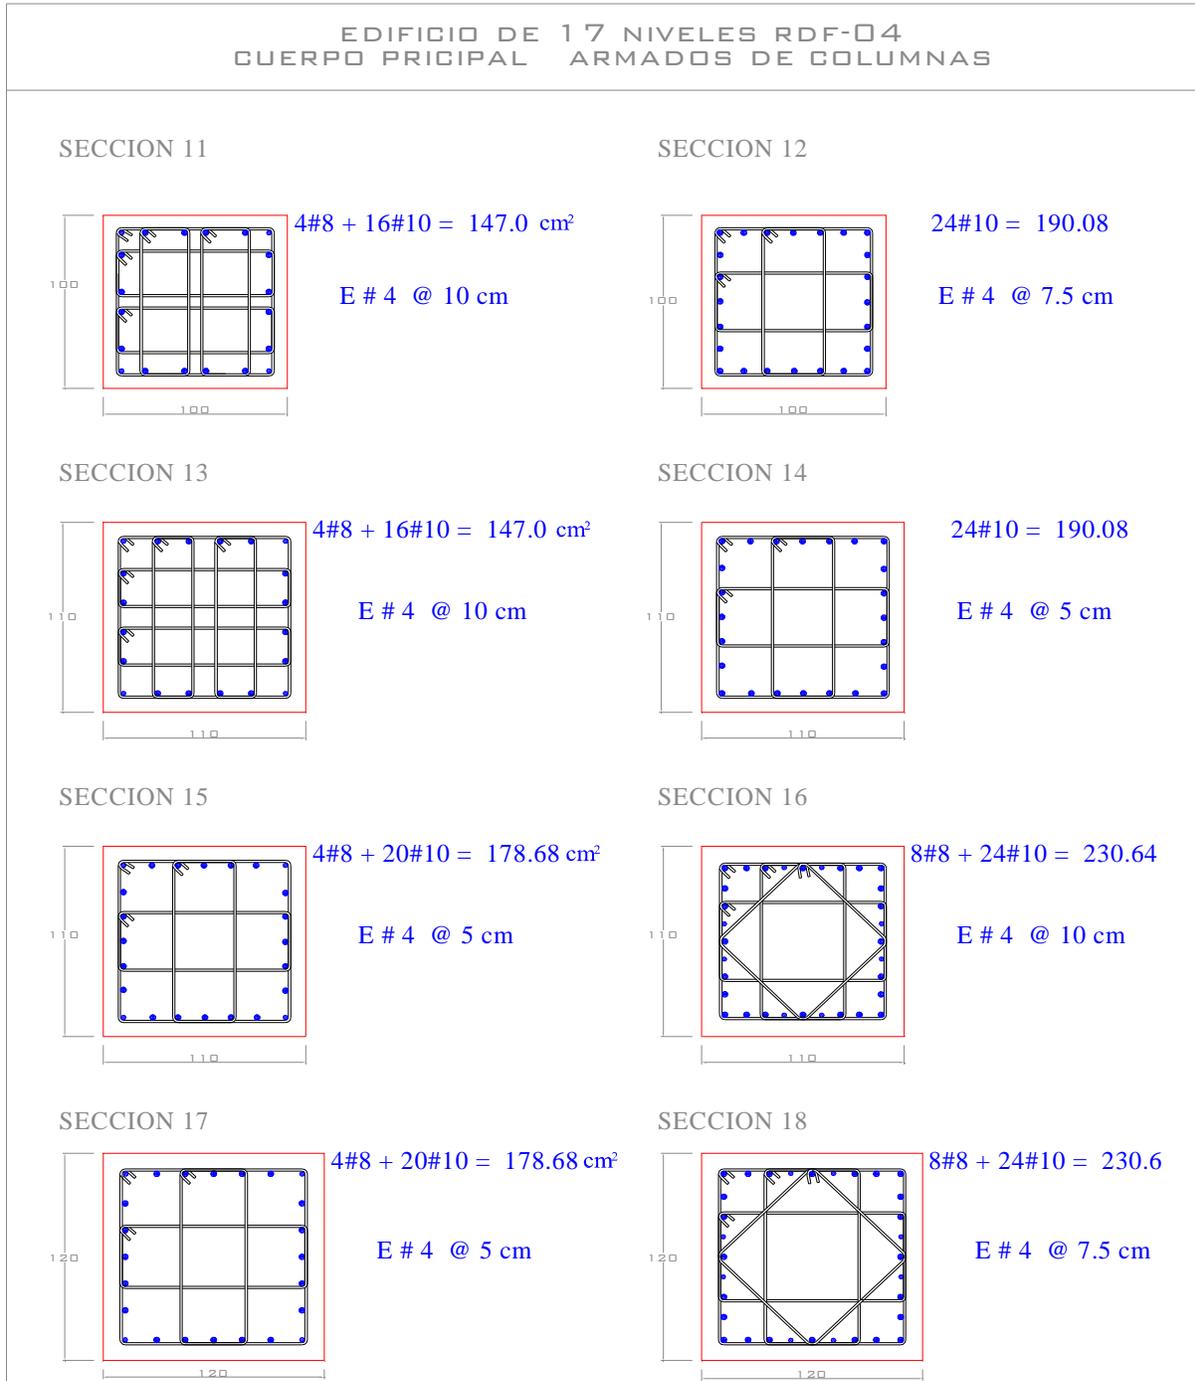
Armados de acero longitudinal y transversal propuestos en columnas, edificio 17 niveles, Cuerpo Principal (caso A) de las NTC-Sismo, RDF-04
